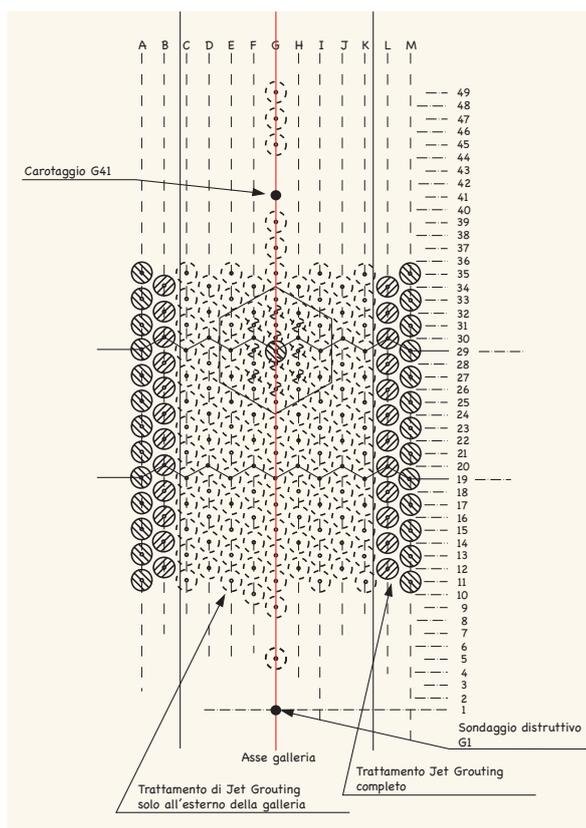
Pianta della disposizione delle colonne Jet Grouting.
